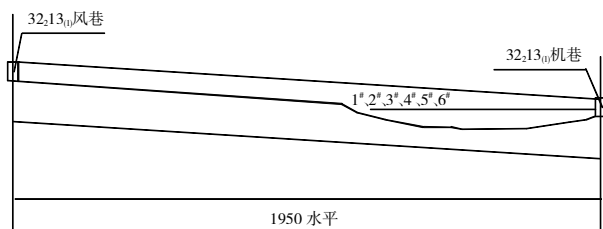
B-B32₂13₍₁₎机巷施工瓦斯抽采钻孔剖面图
